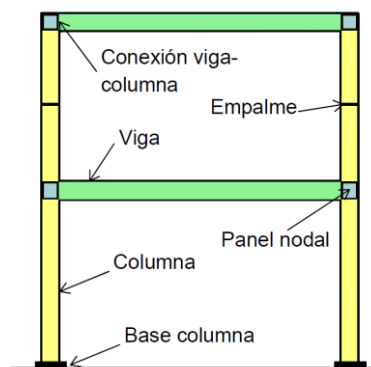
Componentes estructurales de un pórtico no arriostrado. [26]
